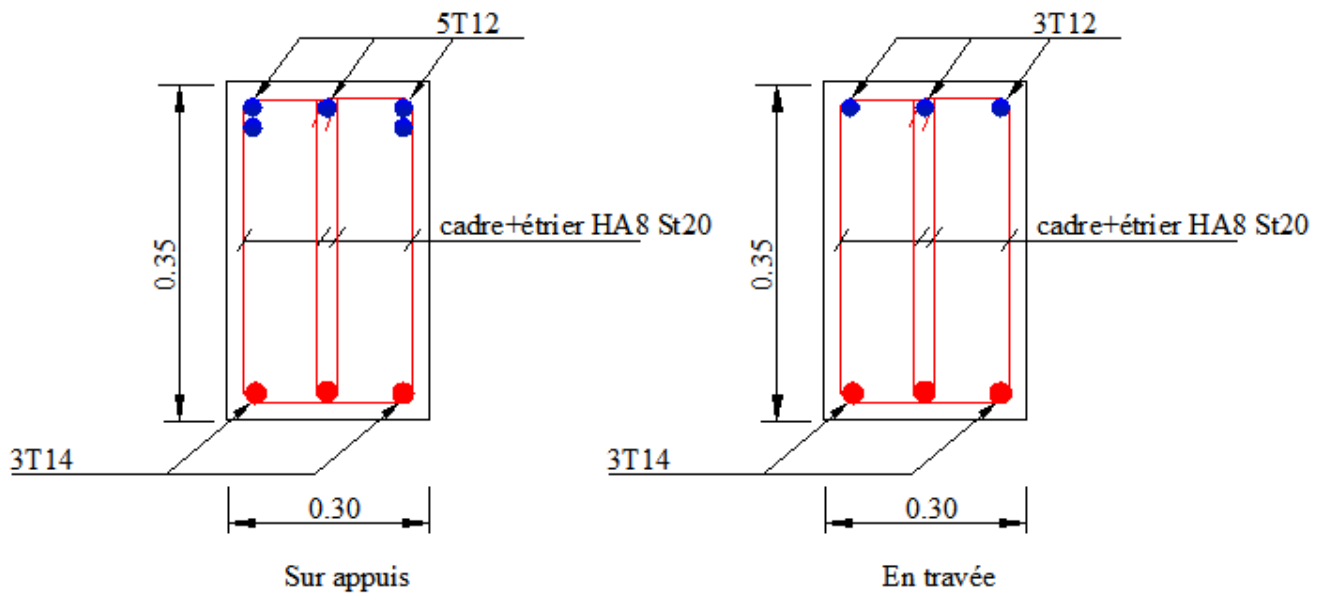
Schéma de ferrailage des poutres -secondaires
